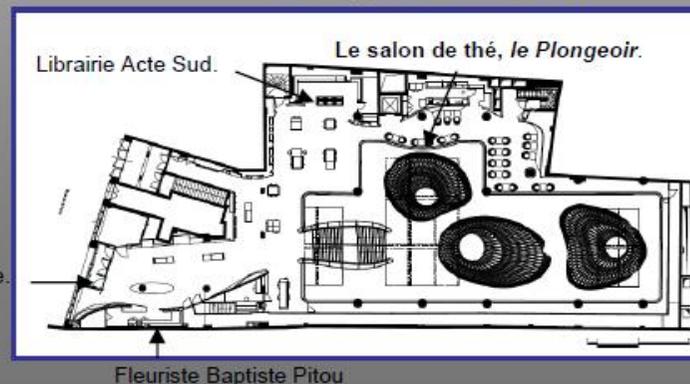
Plan du rez-de-chaussée, dessin agence RDAI, avril 2011.
